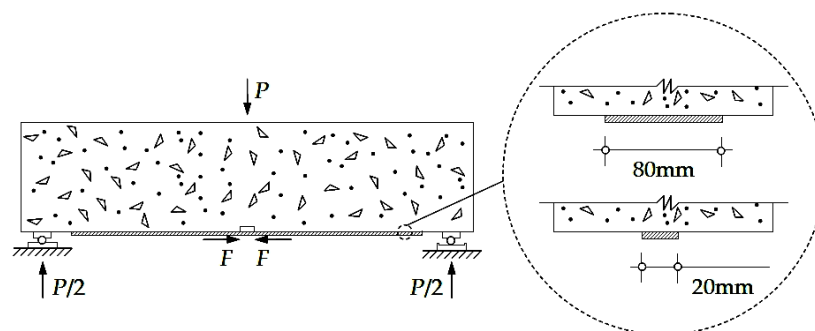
Esquema de forças do ensaio de das vigas de secção rectangular.
